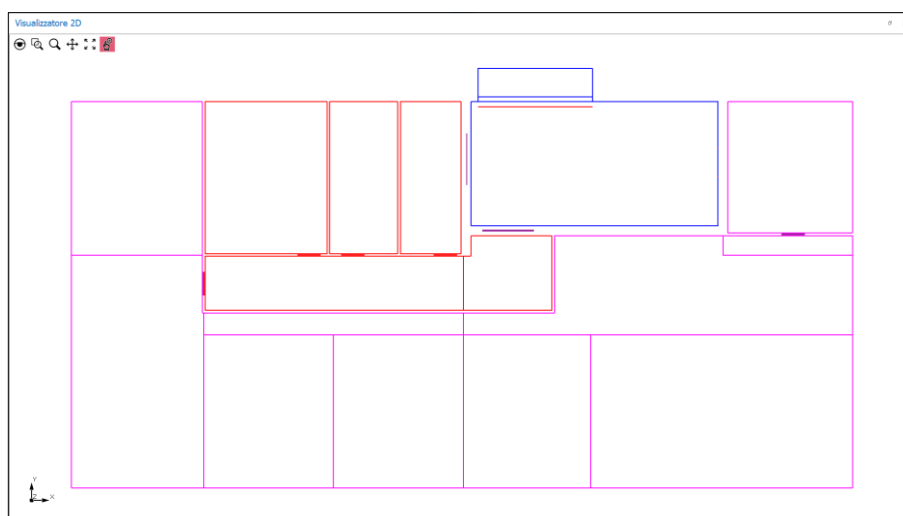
Pannello di presentazione 2D – Vista delle frontiere del piano Seminterrato
